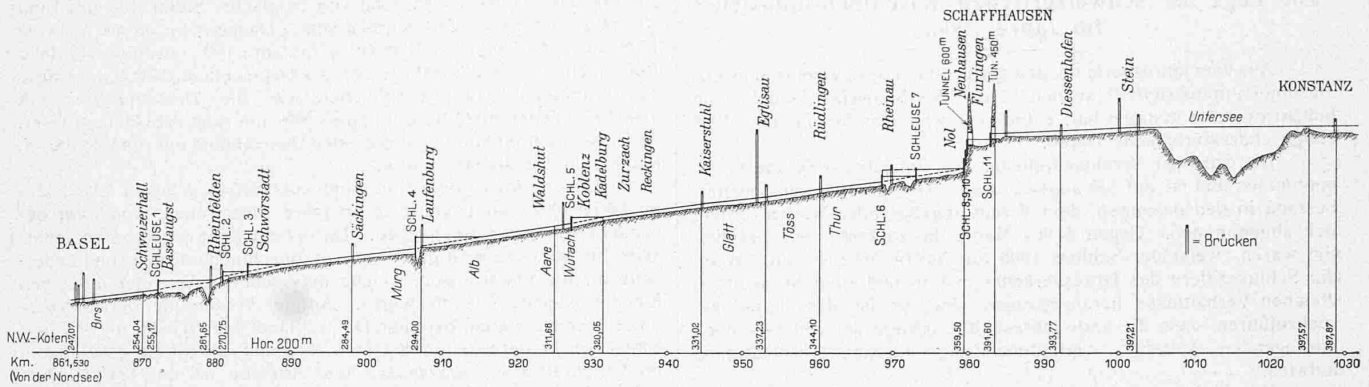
Längenprofil des Rheins von Basel bis Konstanz. — Masstab für die Längen 1 : 900000, für die Höhen 1 : 6000.
